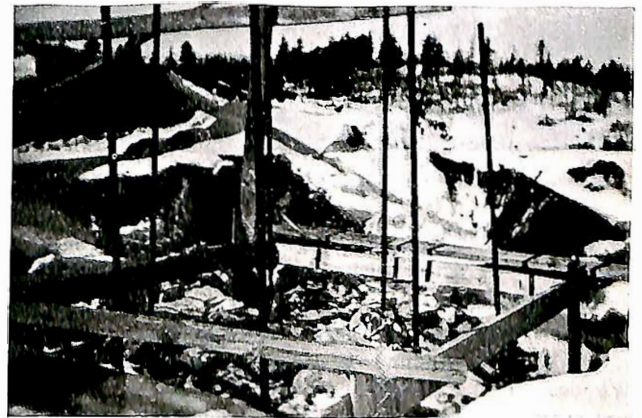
Østre pillar ved søndre bredd; fundamentering.
